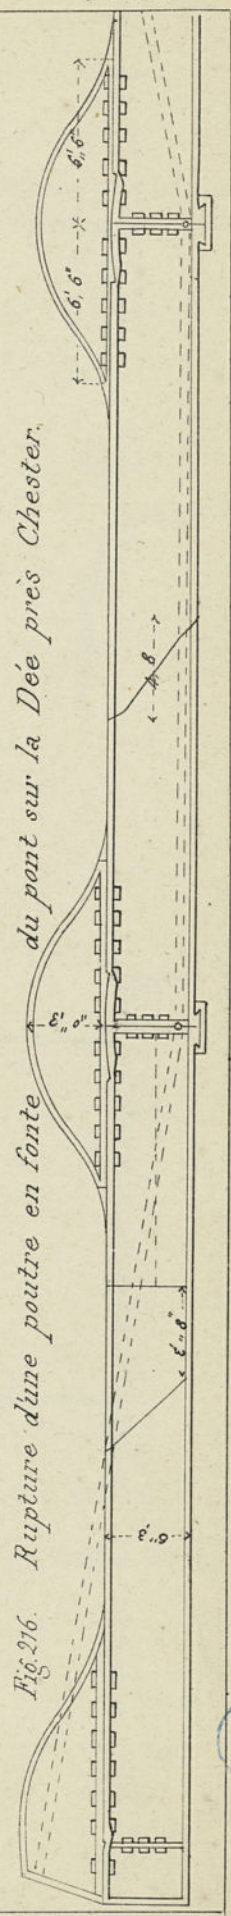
Rupture d'une poutre en fonte du pont sur la Dée près Chester.
